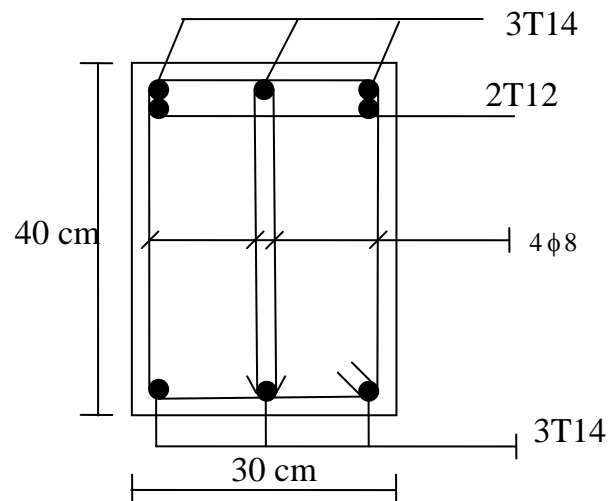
Schéma de ferrailage de la poutre principale (Appuis)
